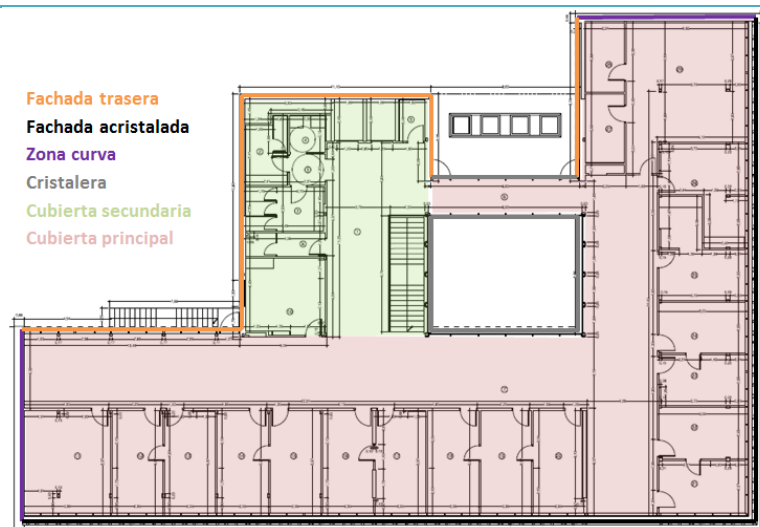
localización de cada cerramiento de la segunda planta en plano acotado.
